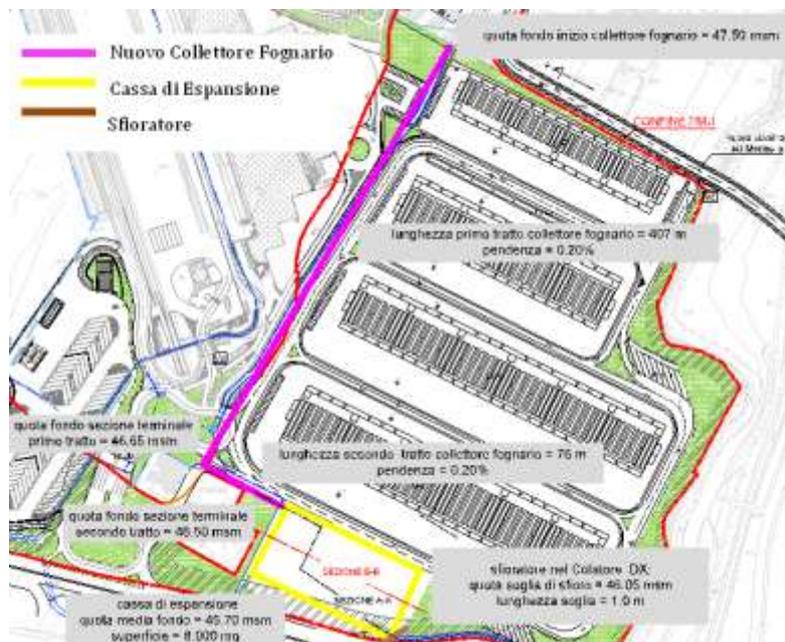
Planimetria dell'area di ampliamento con indicazione delle nuove opere idrauliche
